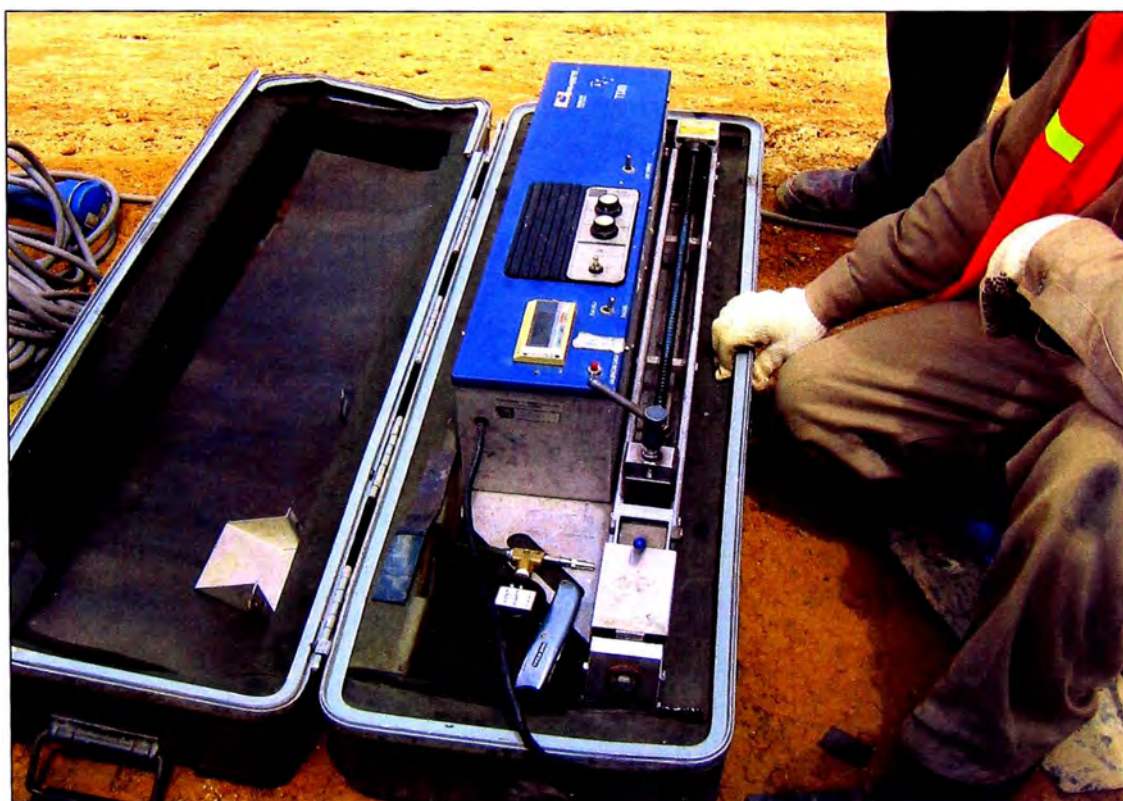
Tensiómetro WO5 utilizado en los ensayos de corte y ensayos de pelaje de muestras de soldadura de geomembrana.
